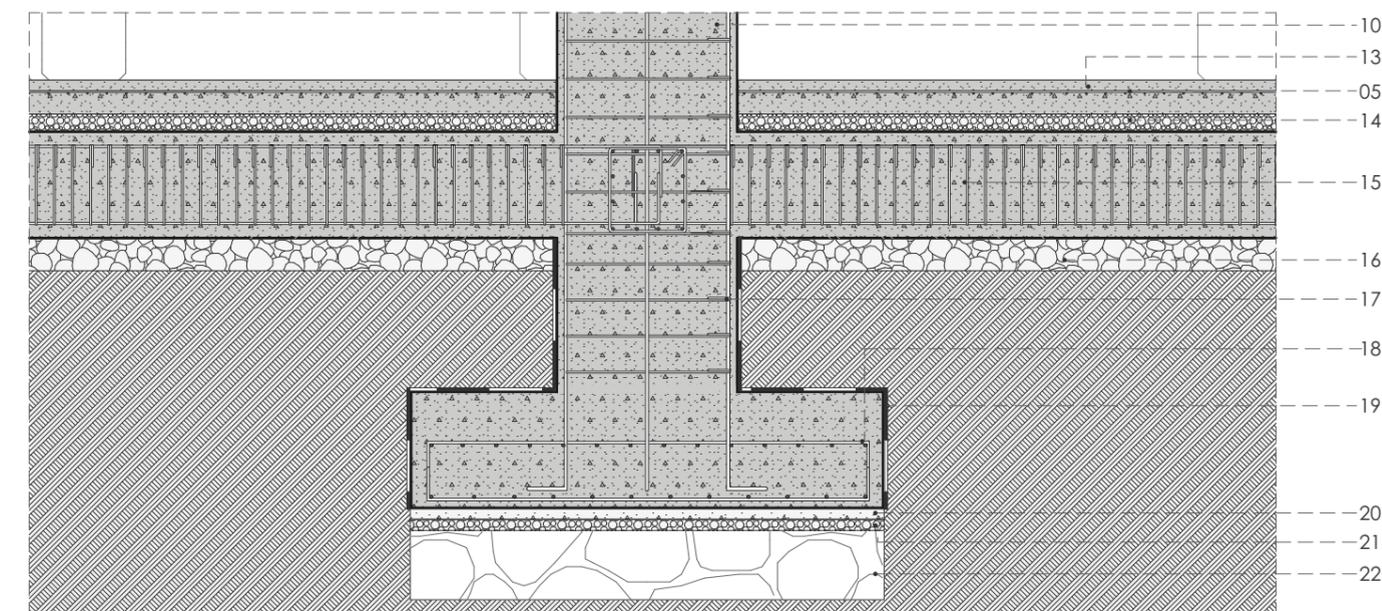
Detalle 01 - zapata Fuente: Propia, 2022
